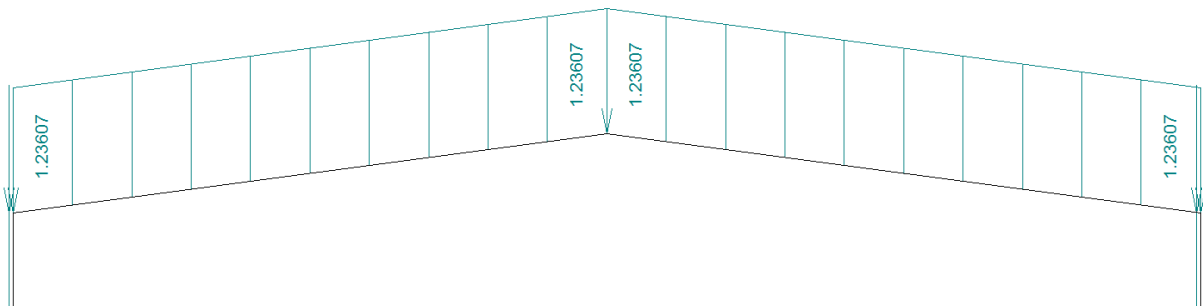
Cargas permanentes sobre la cubierta en pórtico interior (kN/m)
